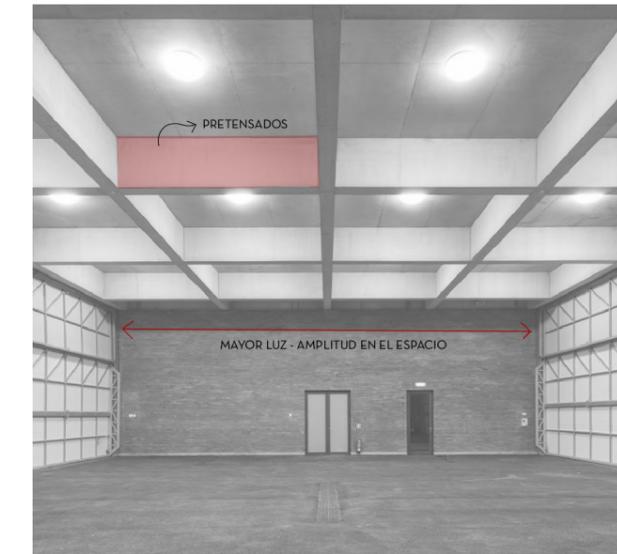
Esquema análisis constructivo/estructural Santo Tirso. Fuente: Elaboración Propia
